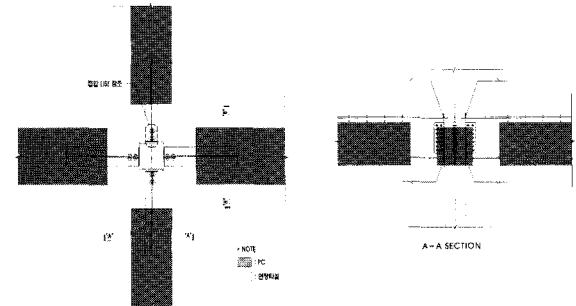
보와 기둥 접합 용접타입(WELDING)
